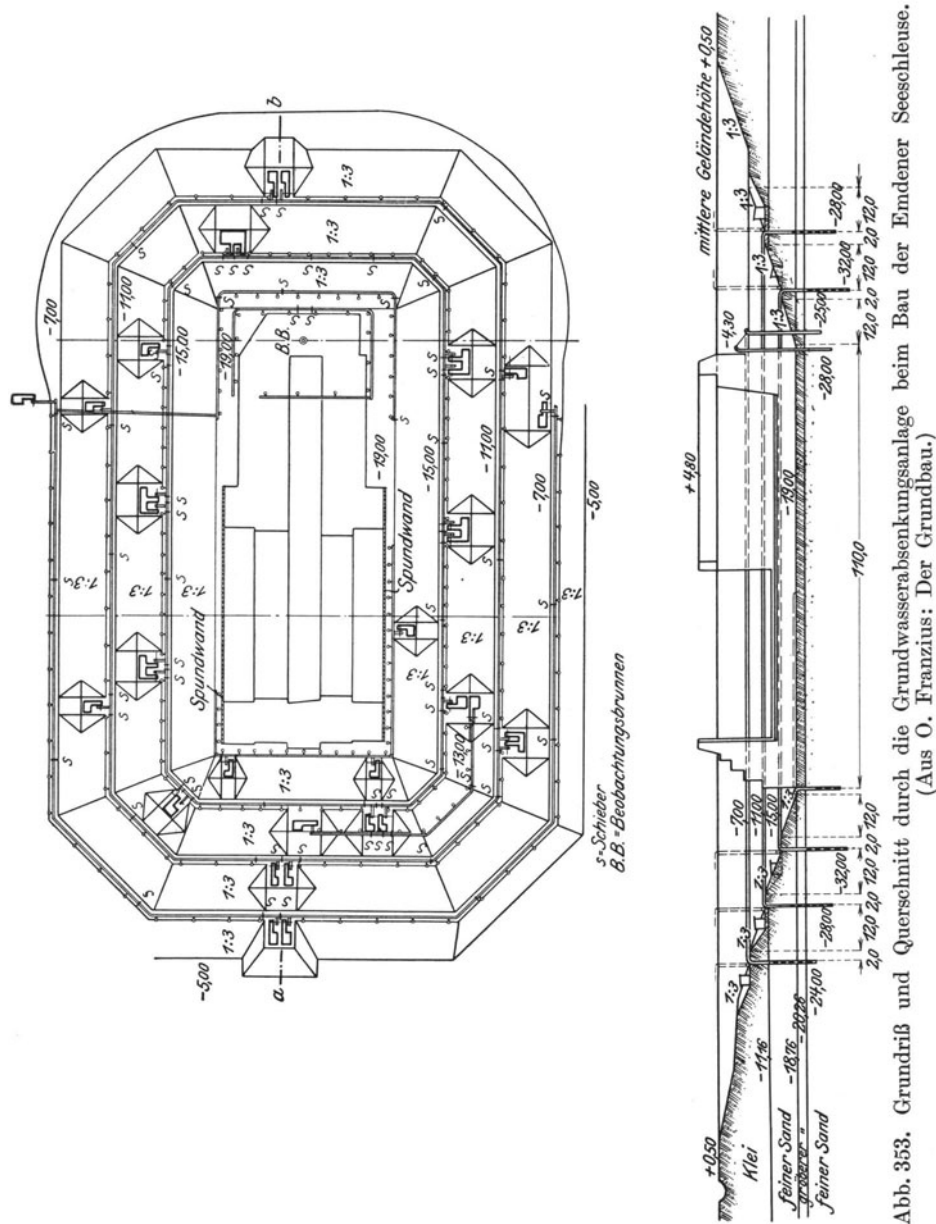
Grundriß und Querschnitt durch die Grundwasserabsenkungsanlage beim Bau der Emdener Seeschleuse. (Aus O. Franzius: Der Grundbau.)
